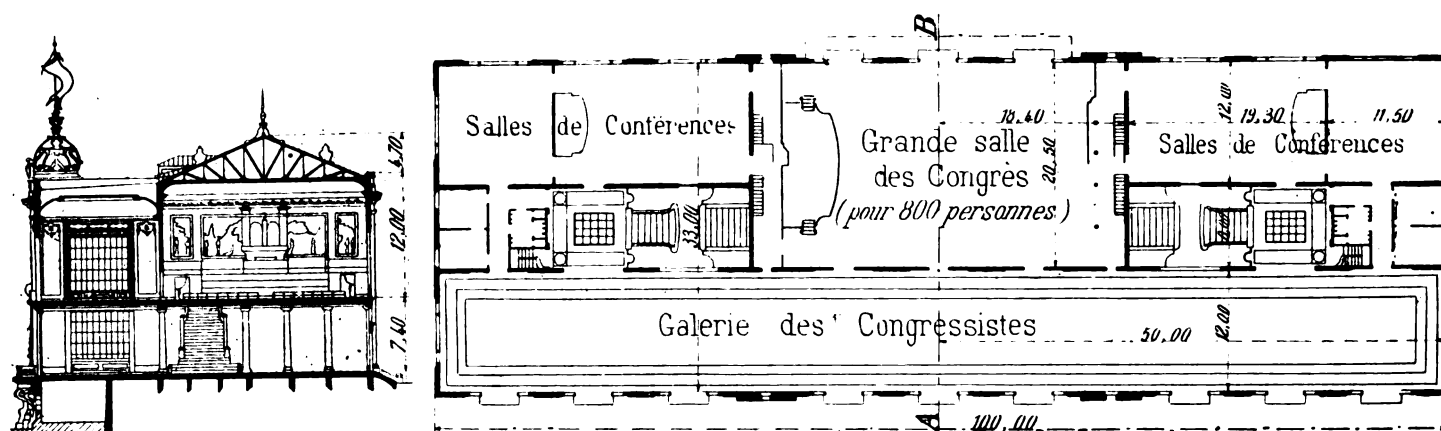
et 4. — Coupe transversale et plan du premier étage du Palais des Congrès.
